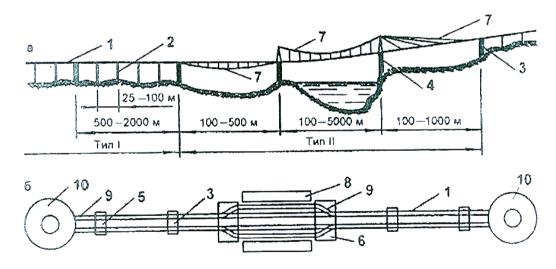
Линейная схема трассы: а — вид сбоку; б — вид сверху;
